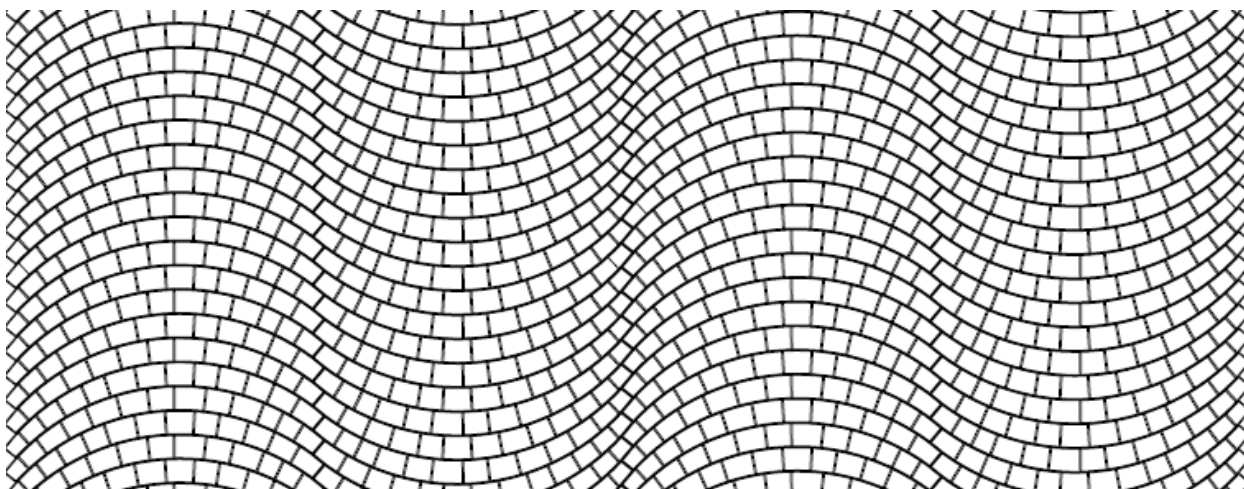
Schema pavimentazione in autobloccanti a doppio arco
